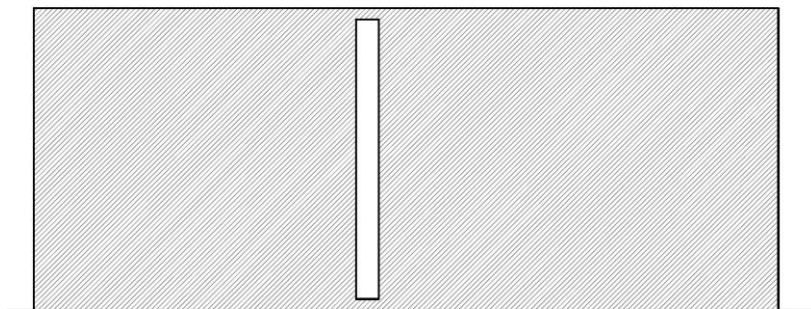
Muro Oeste Auditorio. Fuente: Elaboración propia
